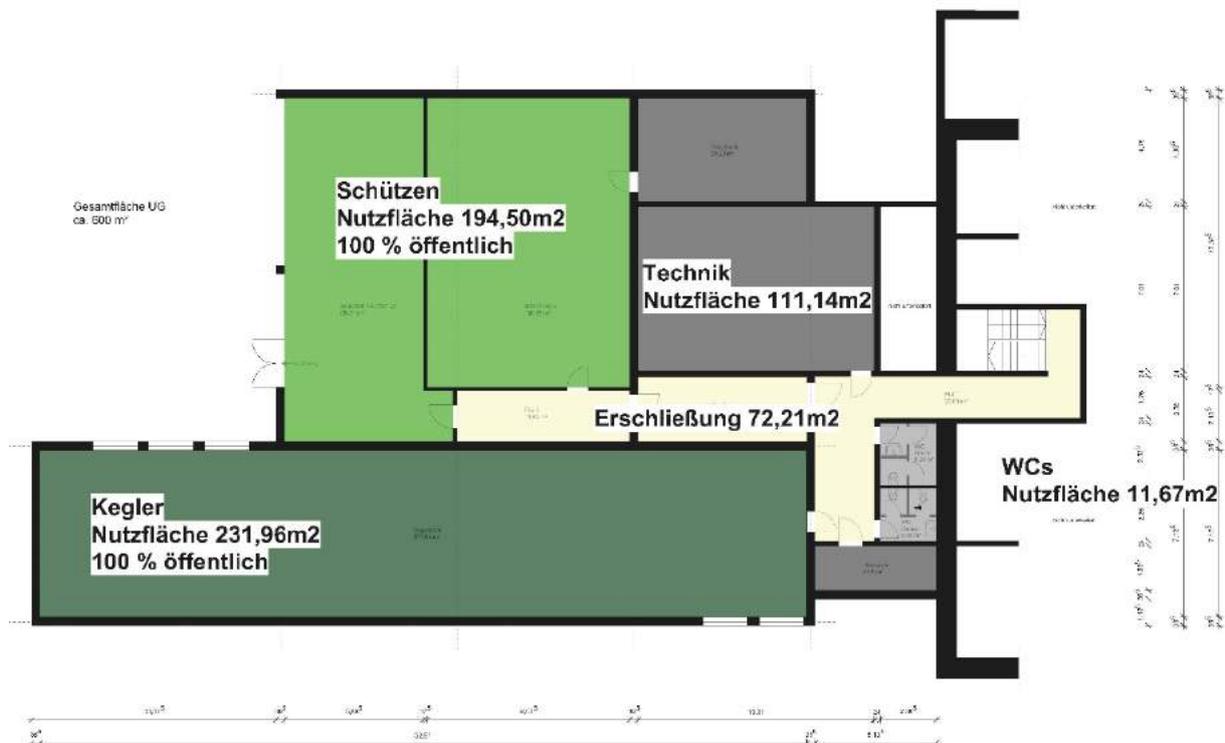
Dorfzentrum Lalling, Variante I, Untergeschoß
